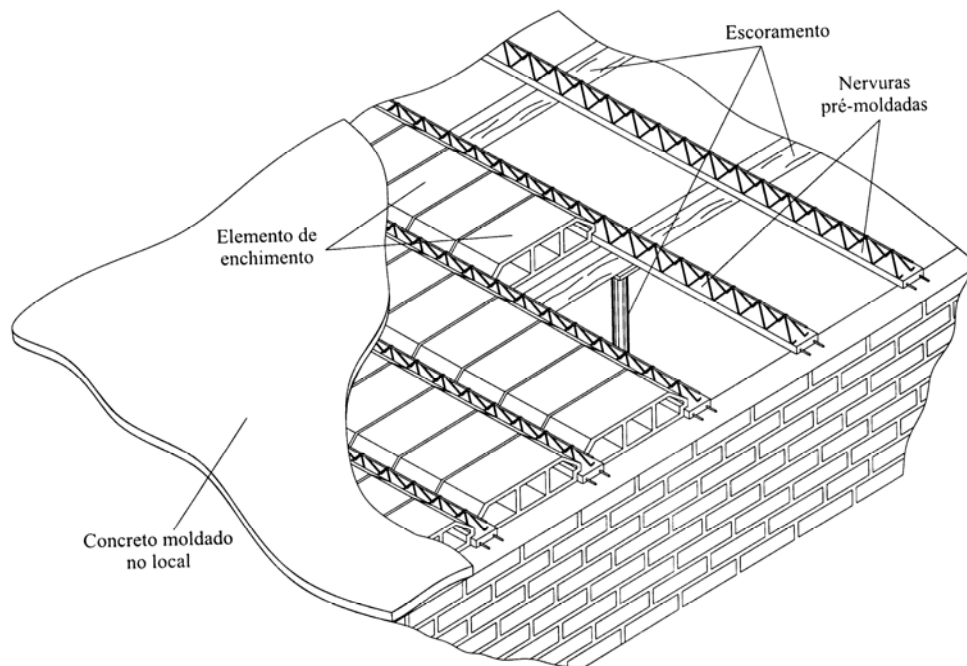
Laje formada por nervuras pré-moldadas [EL DEBS (2000)]
